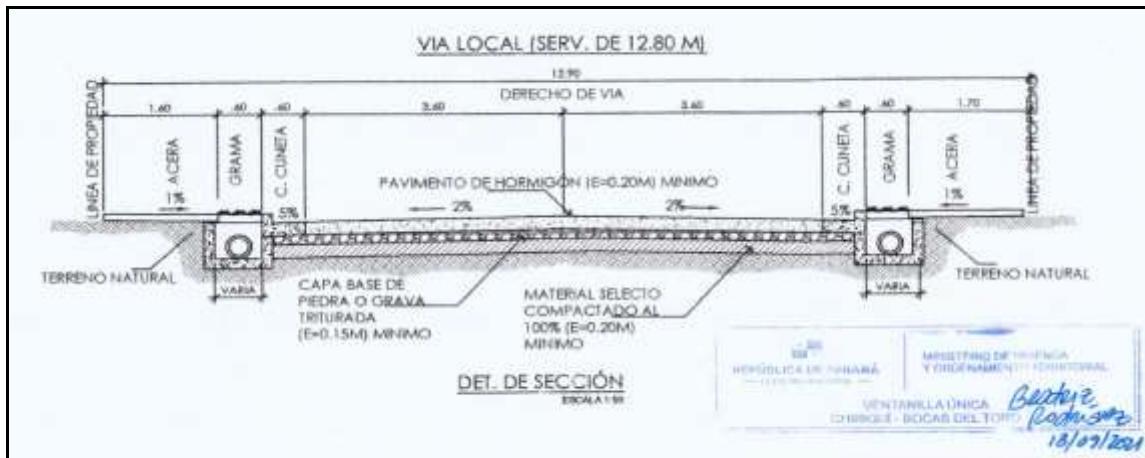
Detalles vía local 12.80 metros, fuente planos del anteproyecto aprobado. Ver Anexo No.2: Planos del proyecto
